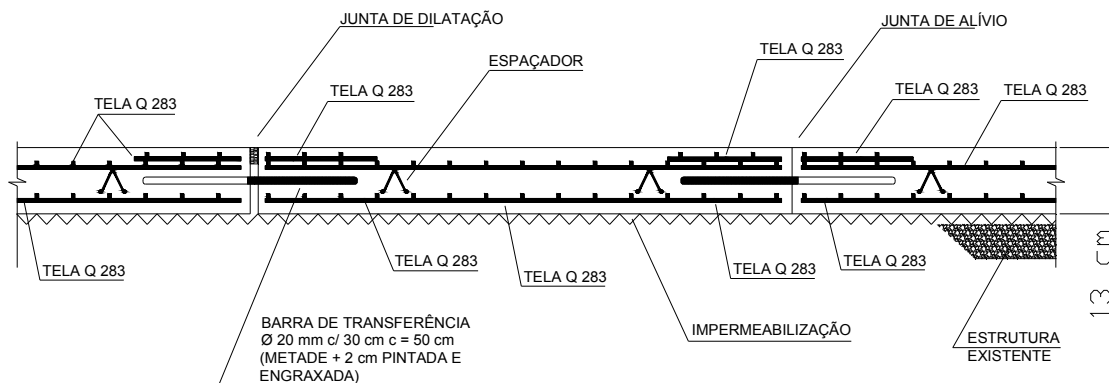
Detalhe das armações do pavimento rígido (Zúniga & Costa, 2001f, com adaptações)
